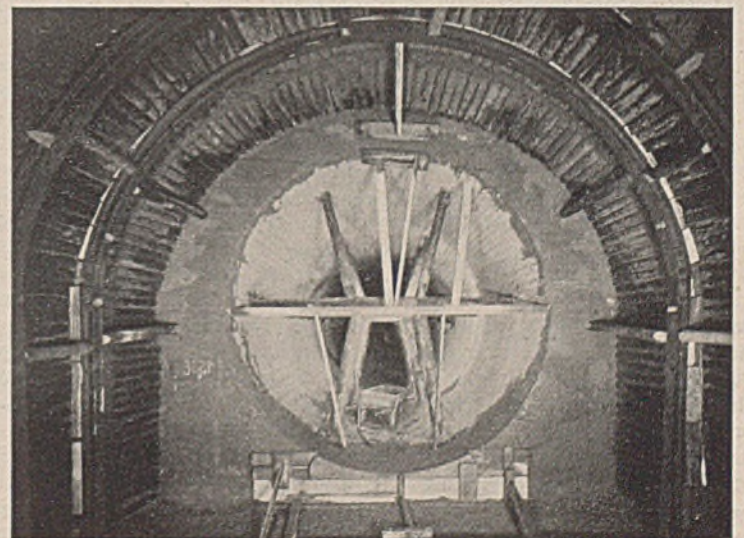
Ausbruchbogen und Tunnelbleche als verloren einbetoniert.
